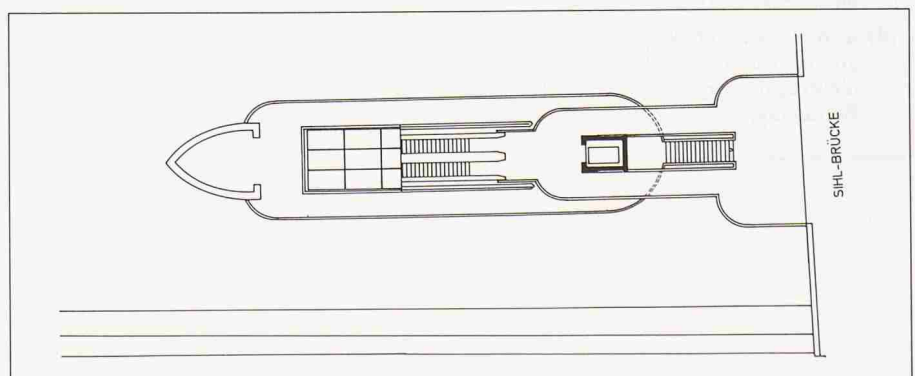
Grundriss auf Ebene Sihlbrücke (Massstab 1:200)
